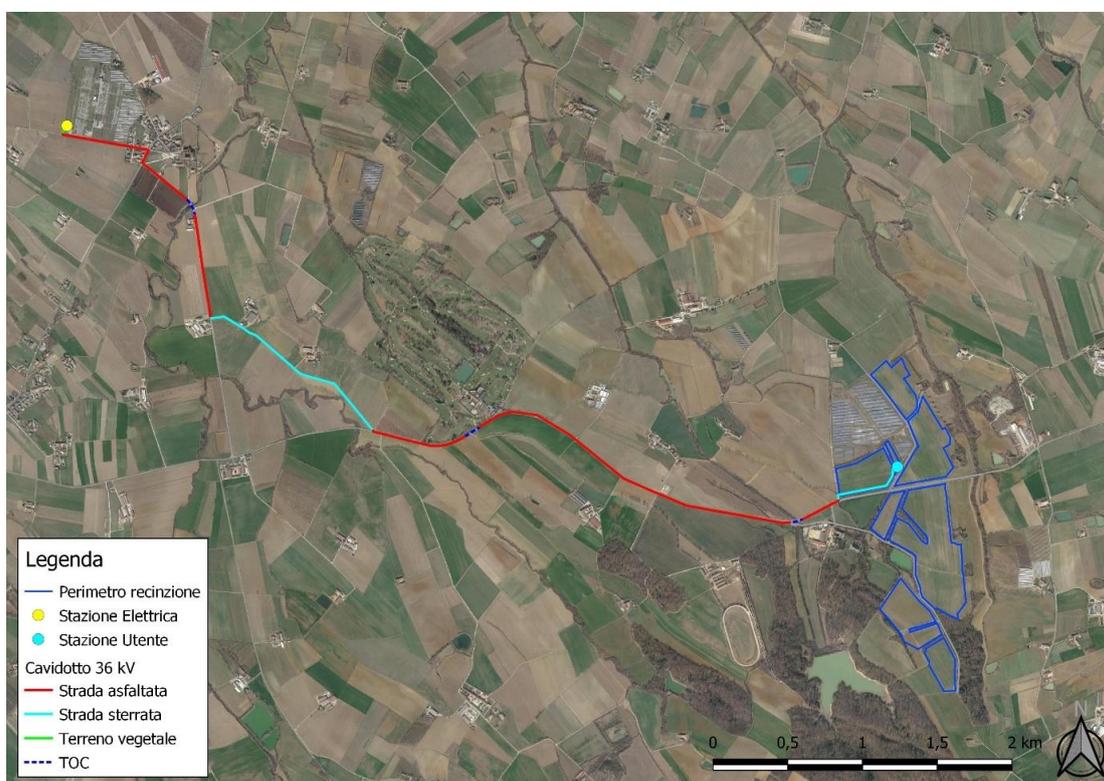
Planimetria su Ortofoto del Cavo di Connessione (fonte: S.I.A. del progetto)
